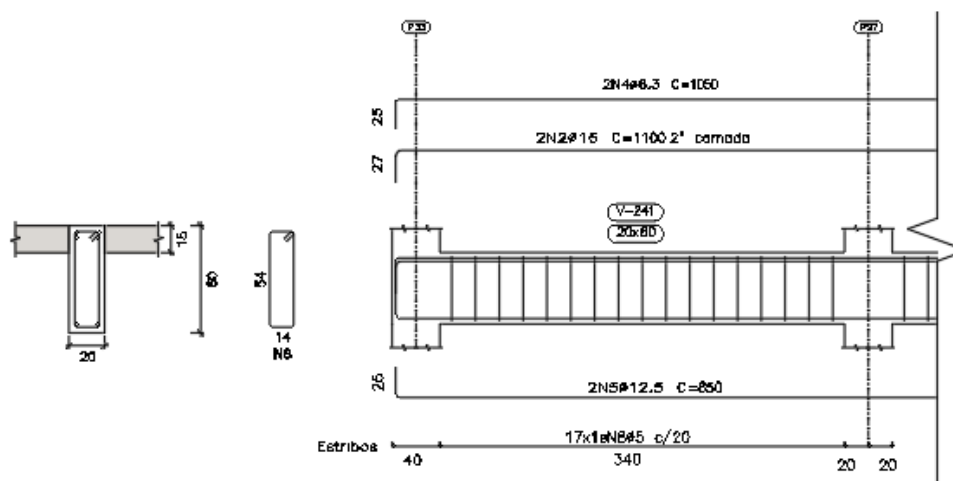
Seção transversal e longitudinal de viga intermediária
